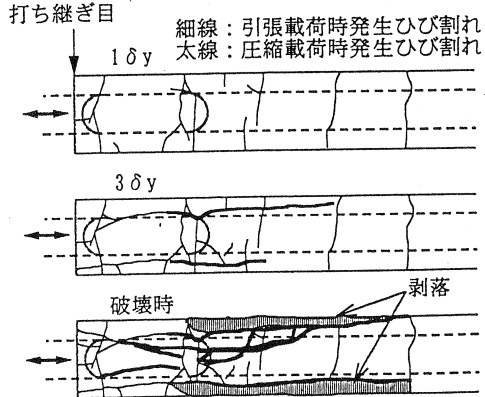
ひび割れ図 (CASE-4 供試体)
